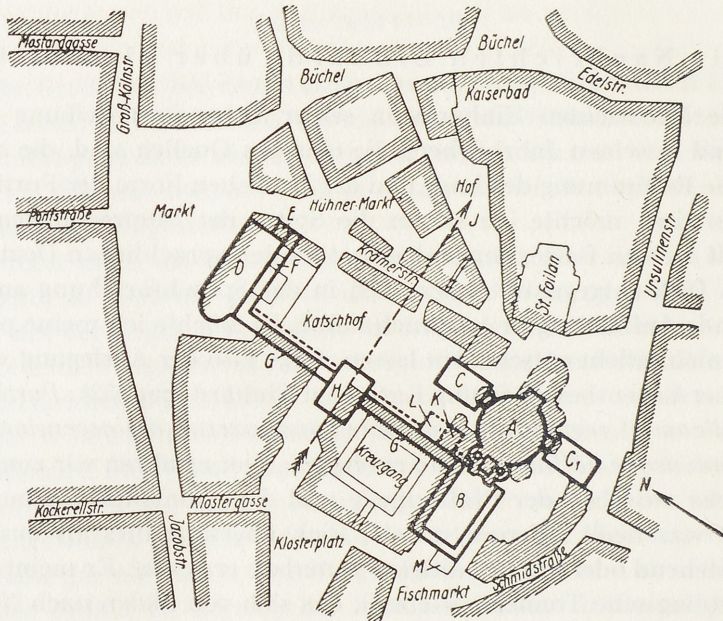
Lageplan der Aachener Pfalz mit der Porticus (G).
